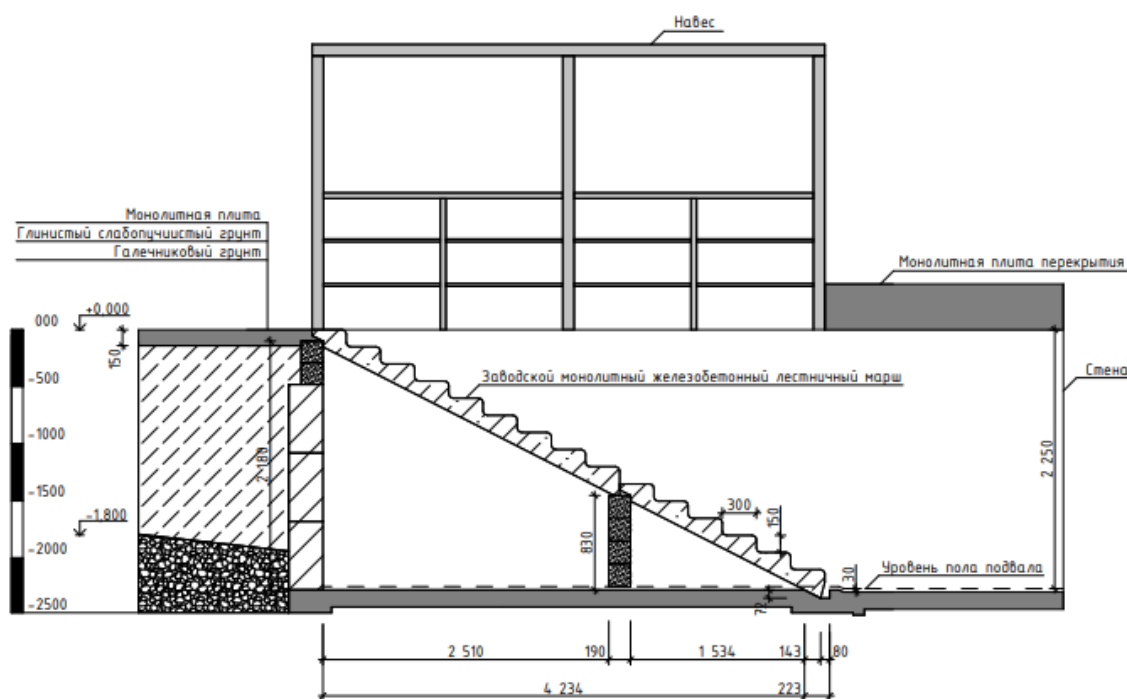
Сборный железобетонный лестничный марш
